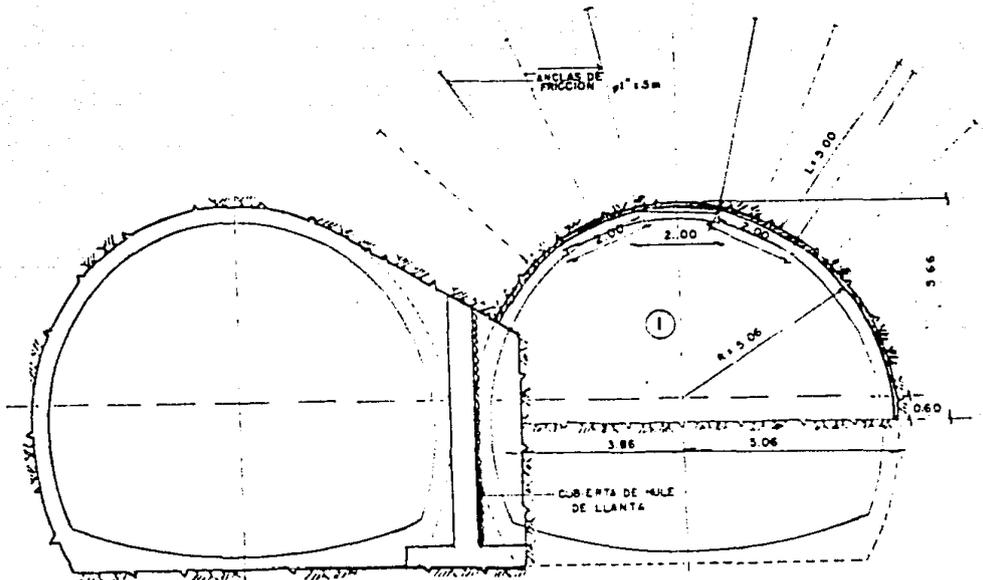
TRAMO DE TRANSICIÓN MEDIA SECCION SUPERIOR
